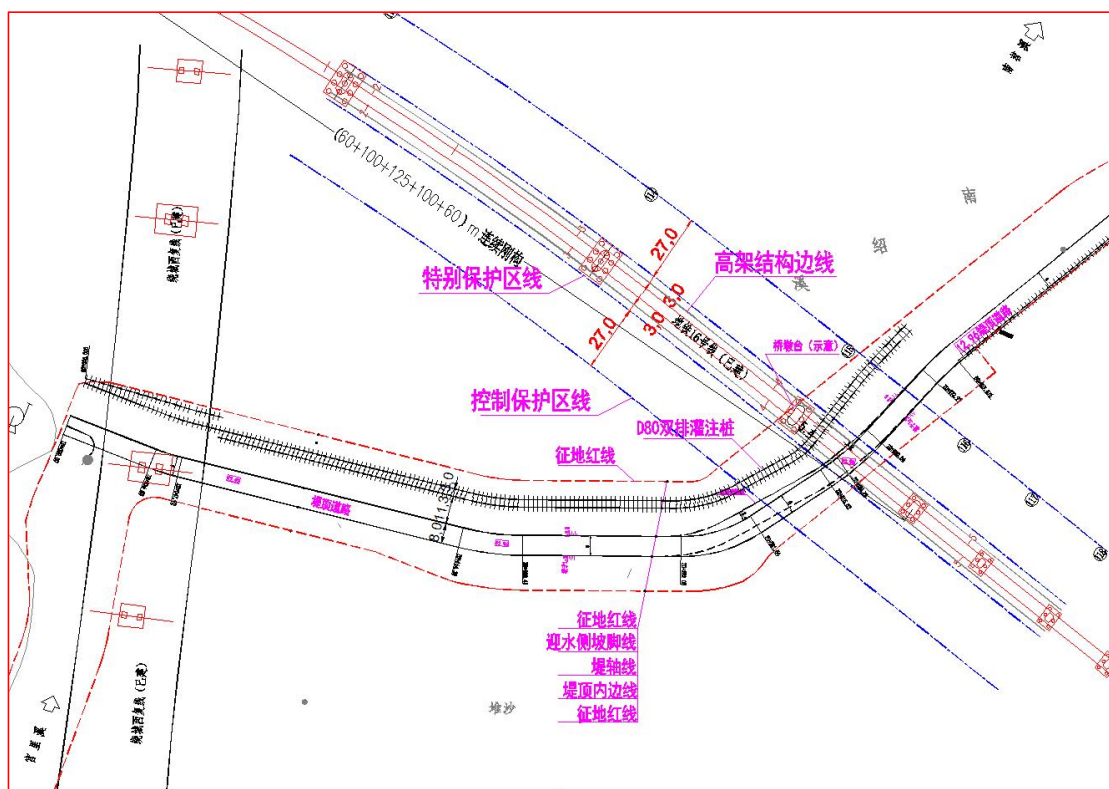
中桥塘堤防工程平面布置图 (详见附件)
